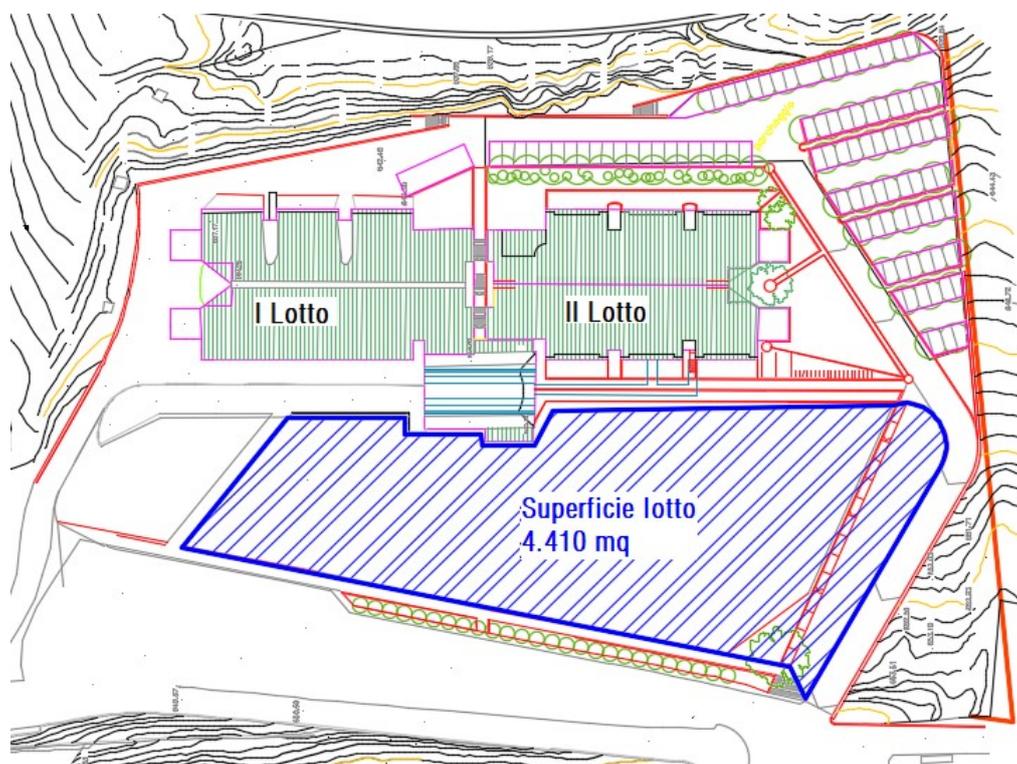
Planimetria III Edificio Polifunzionale con delimitazione del lotto d'intervento
